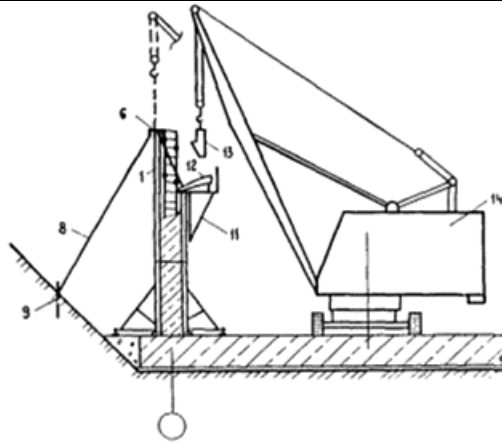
Укладка бетонной смеси с помощью стрелового крана
